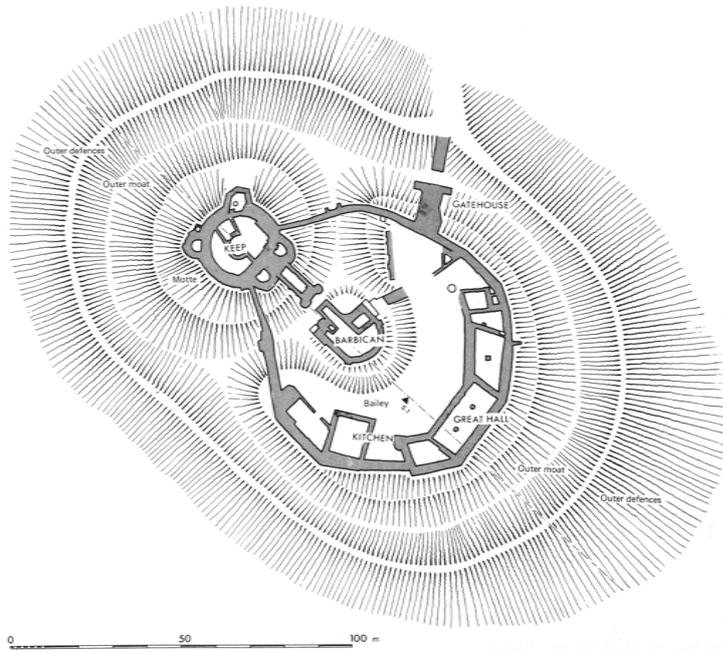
Grundriss Sandal Castle im 13. Jh. (Butler 1991, 34)
